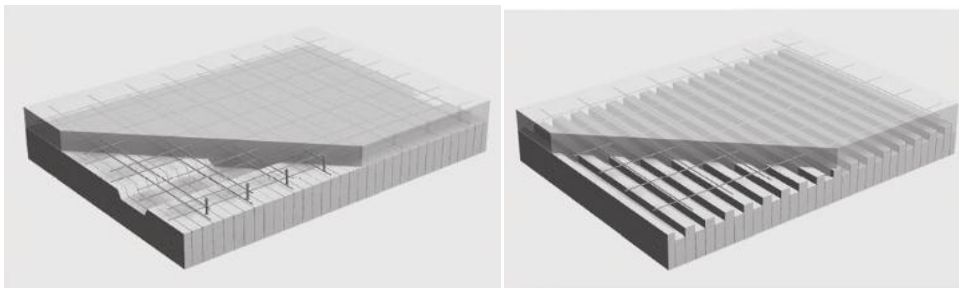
Plancher bois/béton avec éléments de planches juxtaposées.²⁰
